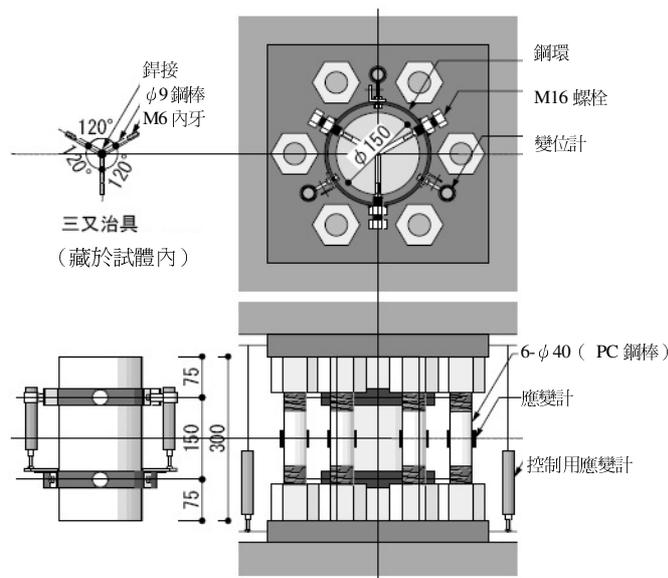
未圍束混凝土柱試體的加載與量測方式 (資料來源：文獻 5)
